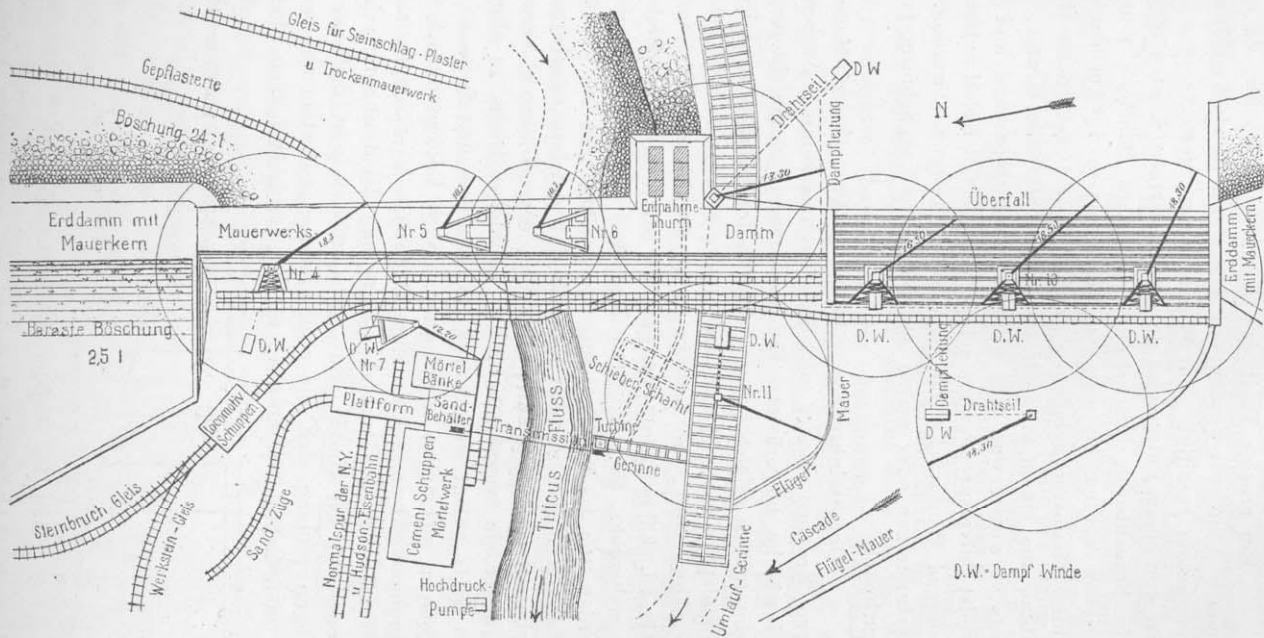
Titicusdamm. Betriebseinrichtung des Bauplatzes.
